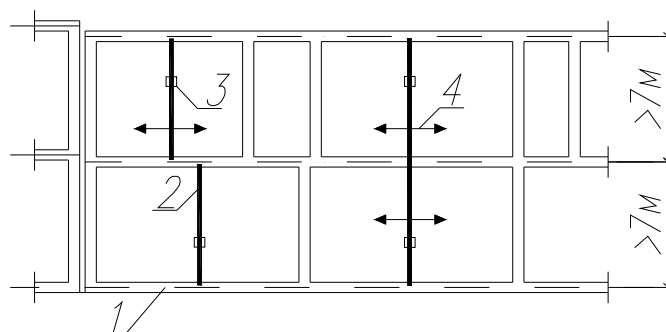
Вариант конструктивной схемы перекрытия с поперечными прогонами и дополнительными колоннами
